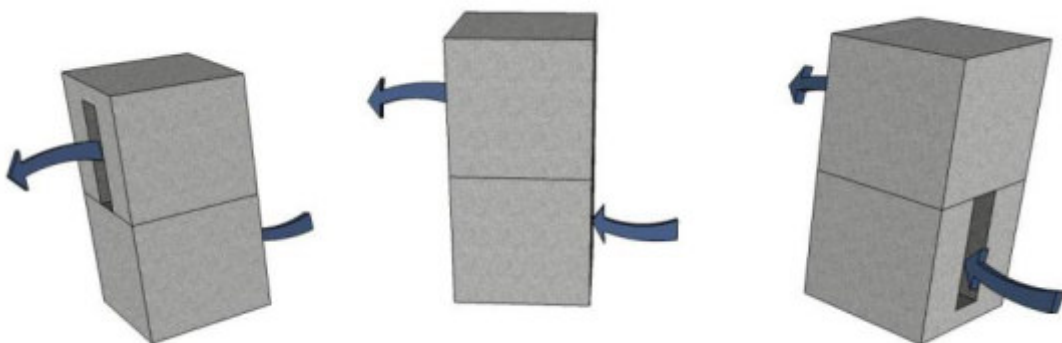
Elemento (ressonador) instalado como vazado
